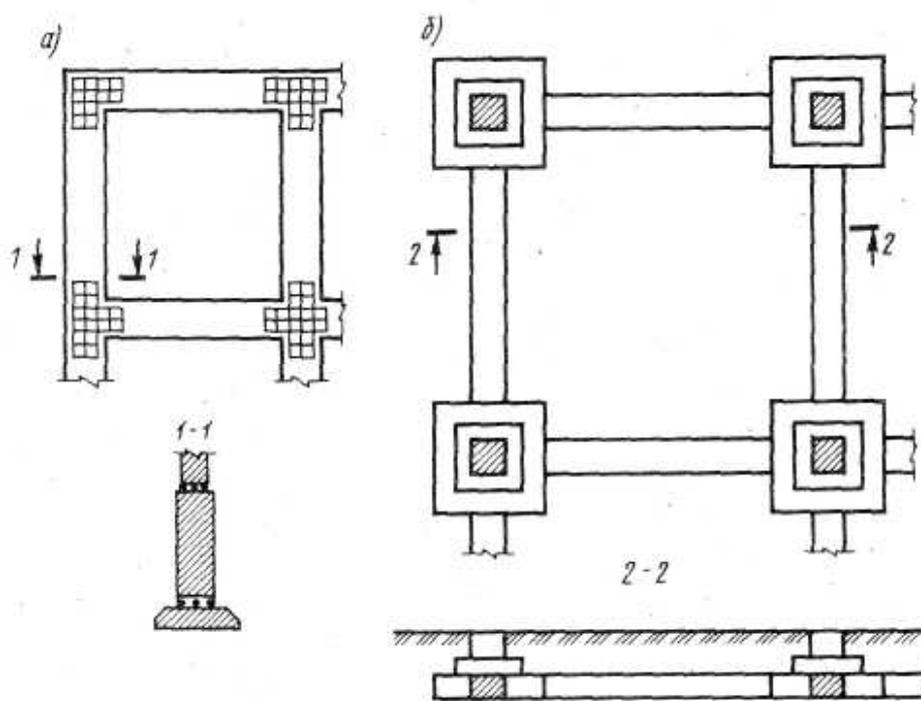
Схемы фундаментов в сейсмических районах
